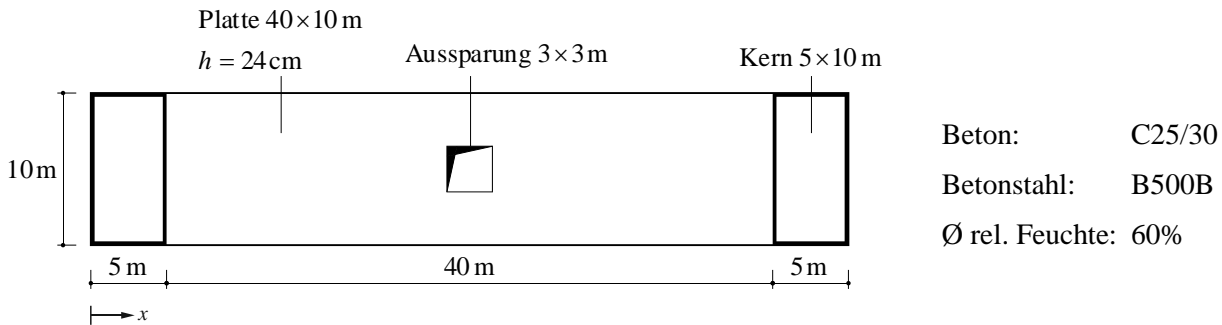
Grundriss, Decke mit Aussparung
